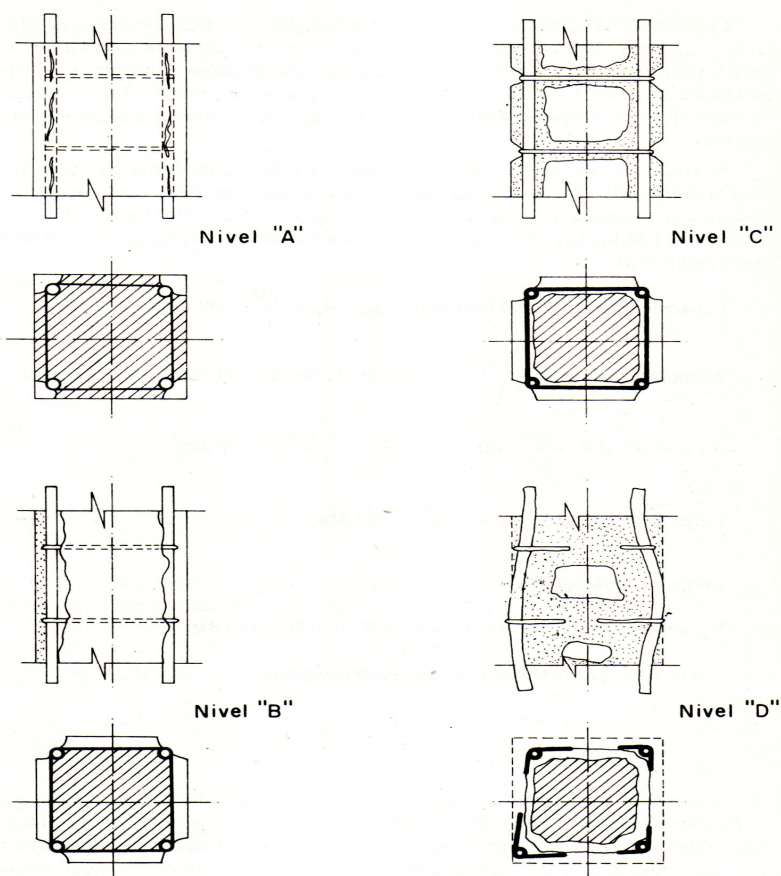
Niveles de fisuración (F. Cánovas)
